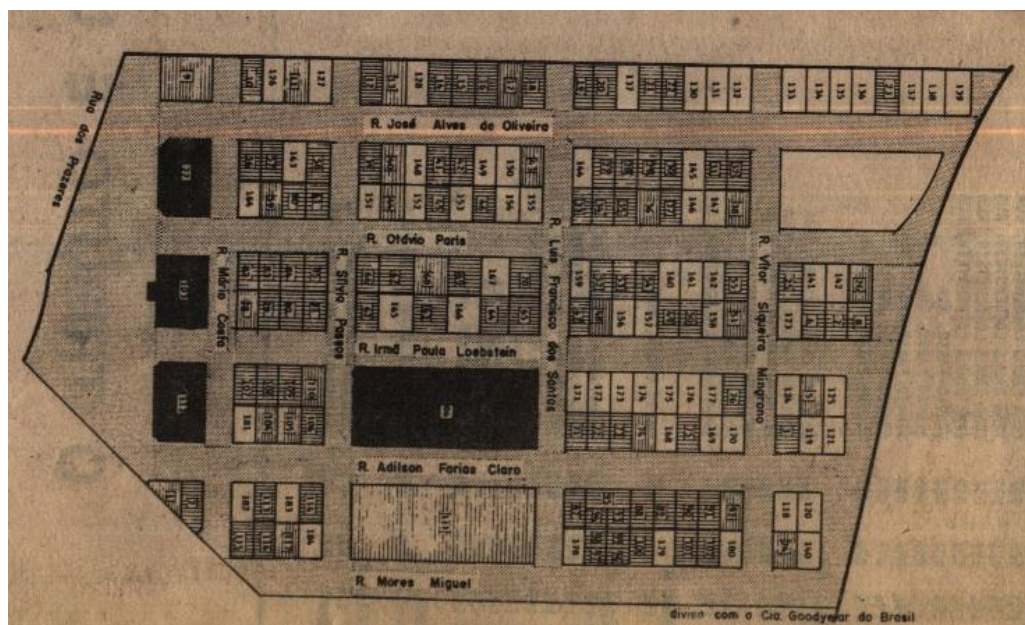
Planta de Localização/ Implantação da Vila Maria Zélia
